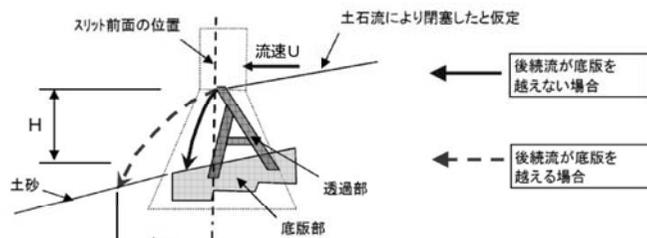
透過型砂防堰堤の後続流の落下位置
